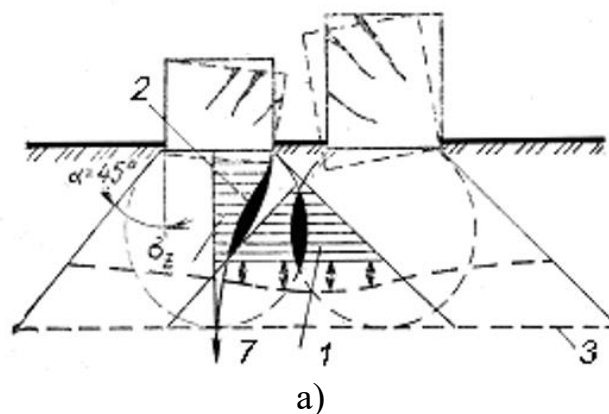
Осад поверхні ґрунту: 1 – існуюча будівля; 2 – будівля що зводиться; 3 – зона осаду; 4 – епюра осаду; 5 – сильно стиснутий ґрунт
